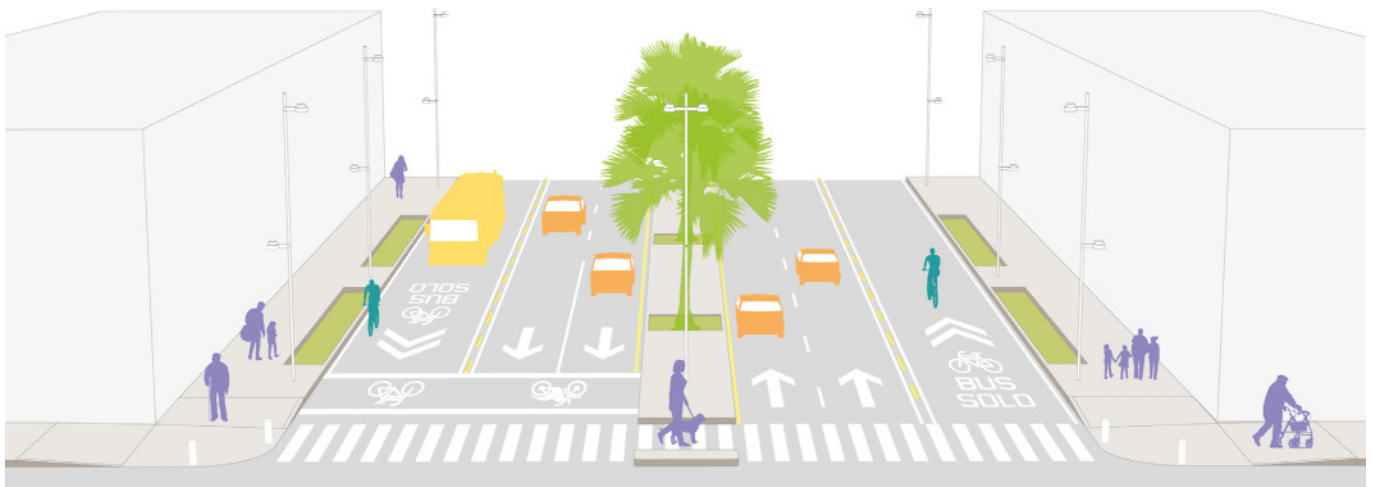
Propuesta de sección para la Av. Salvador Estrella Sadhalá. Fuente: elaboración propia.
